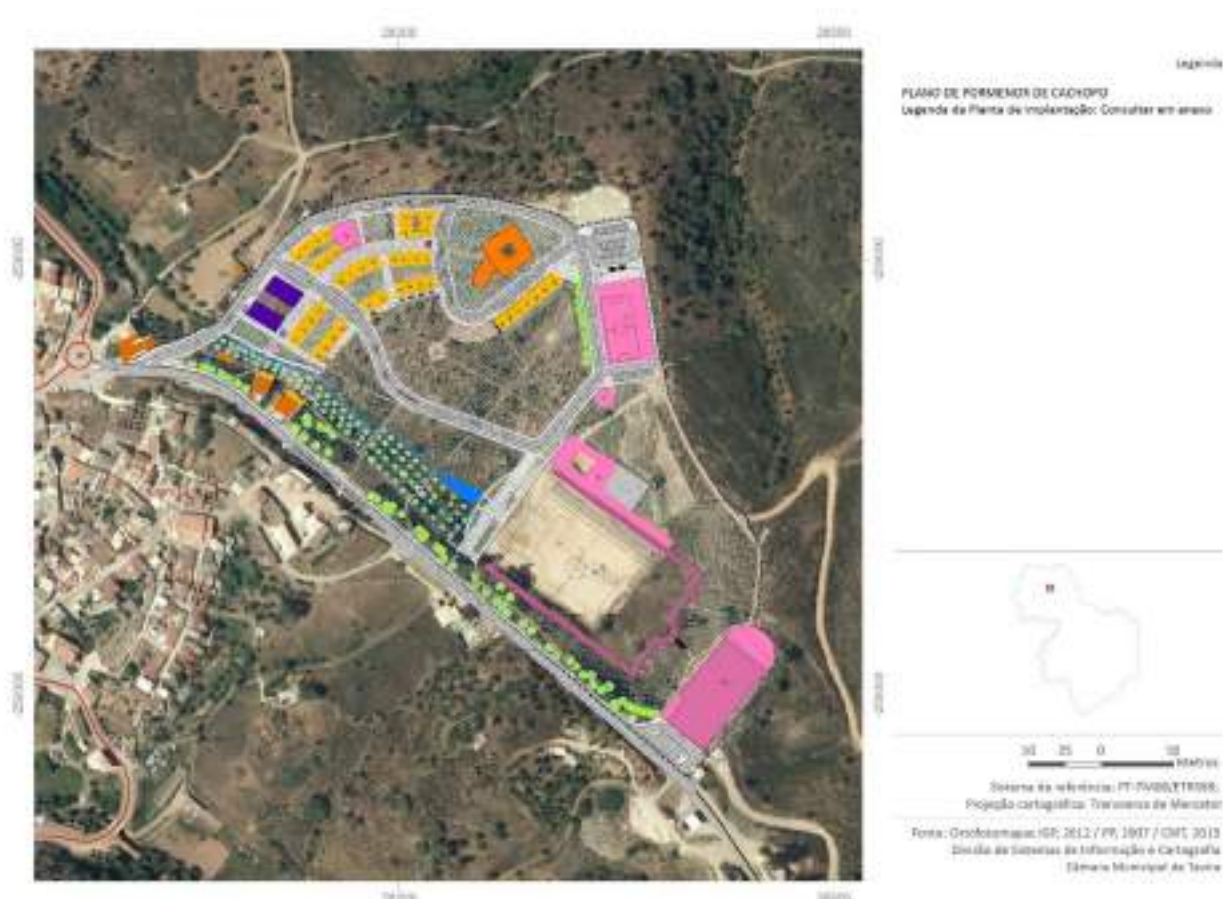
| Planta de Implantação do PP de Cachopo.
